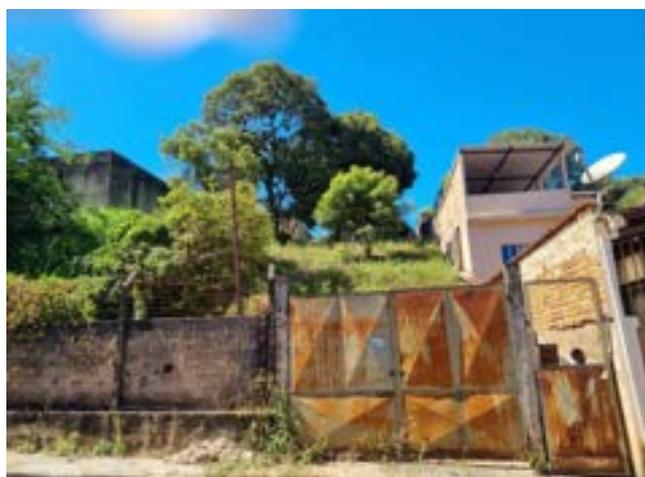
FOTO DA FRENTE DO LOTE, PORTÃO DA GARAGEM E ENTRADA PRINCIPAL
